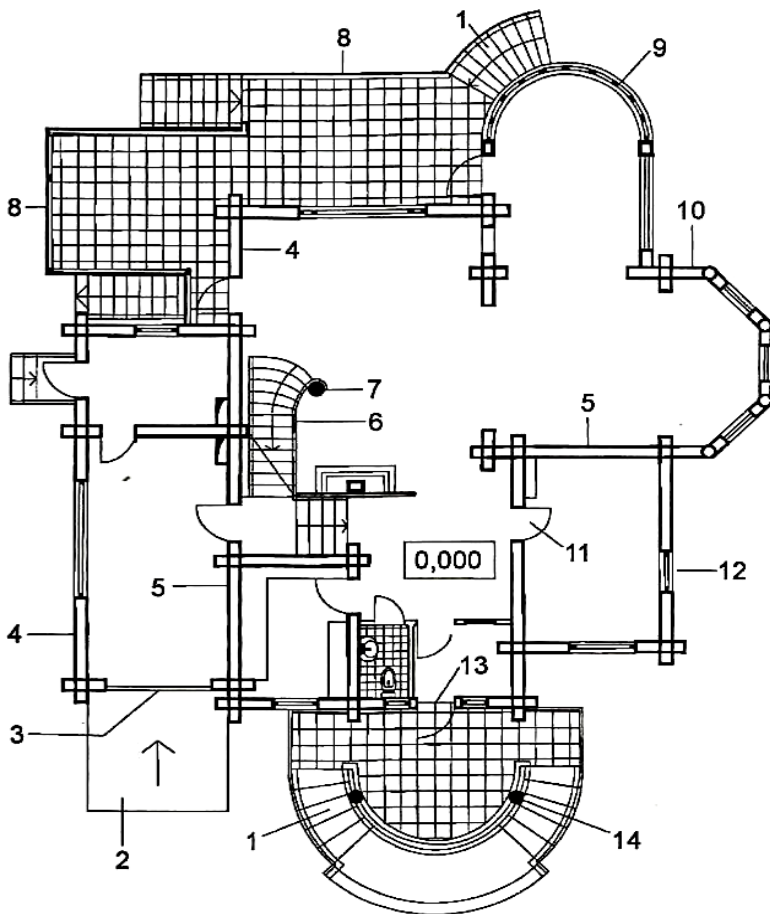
Строительные конструкции малоэтажного жилого дома (чертеж плана):
